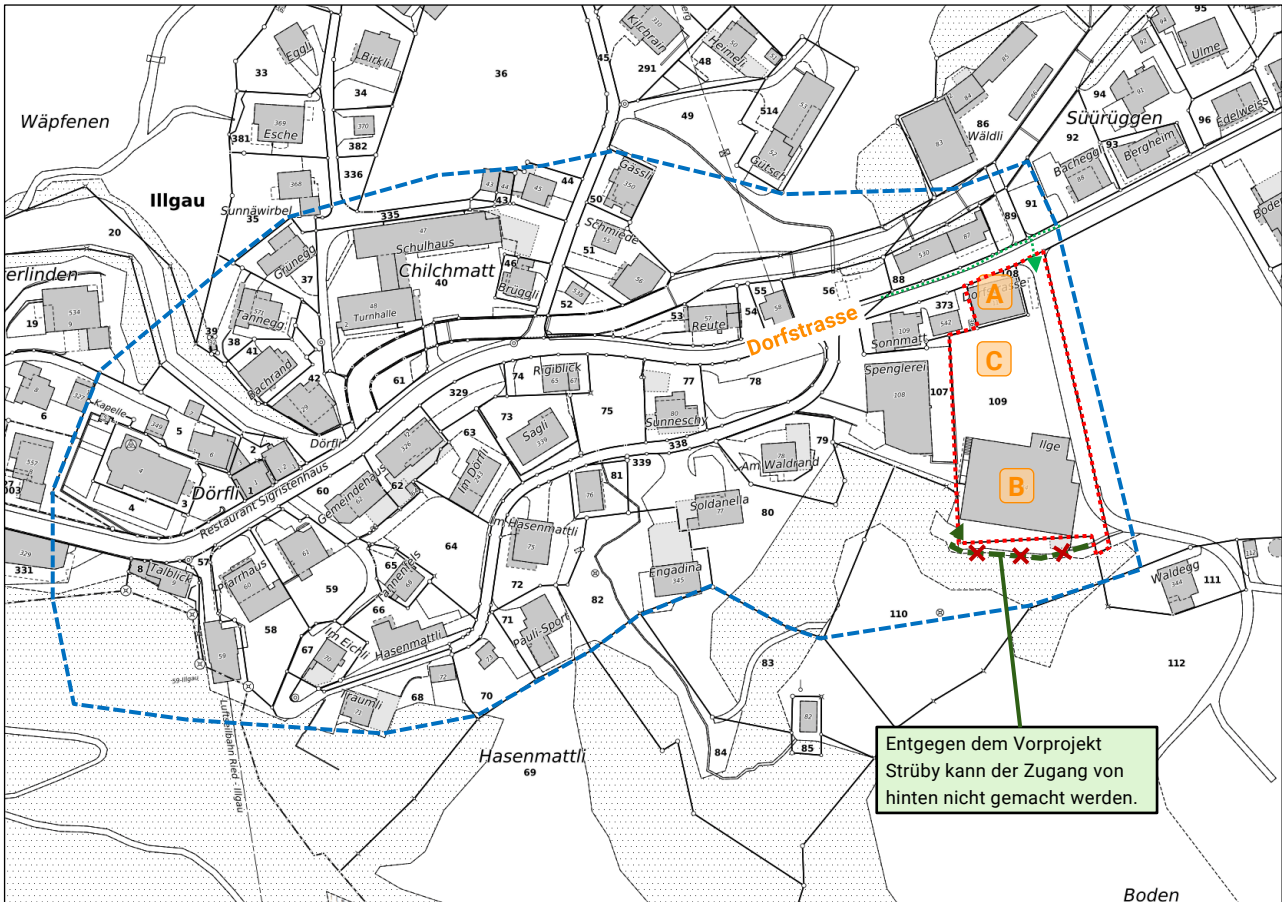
Situation heute mit Perimeter (Quelle Hintergrund: Grundbuchplan, www.map.geo.sz.ch)
